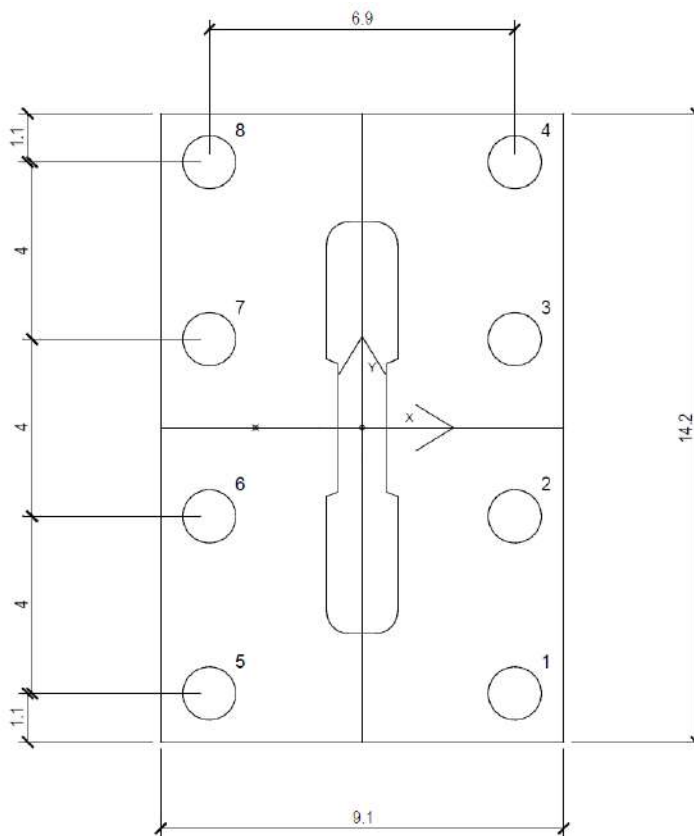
Pianta del plinto pile 1 e 2 con numerazione pali
